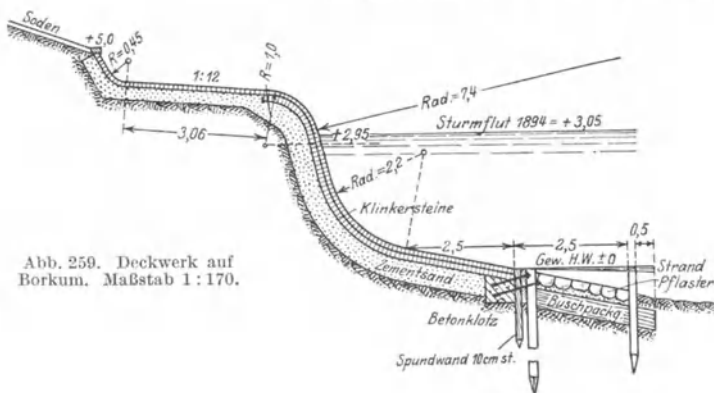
Deckwerk auf Borkum. Maßstab 1 : 170.
